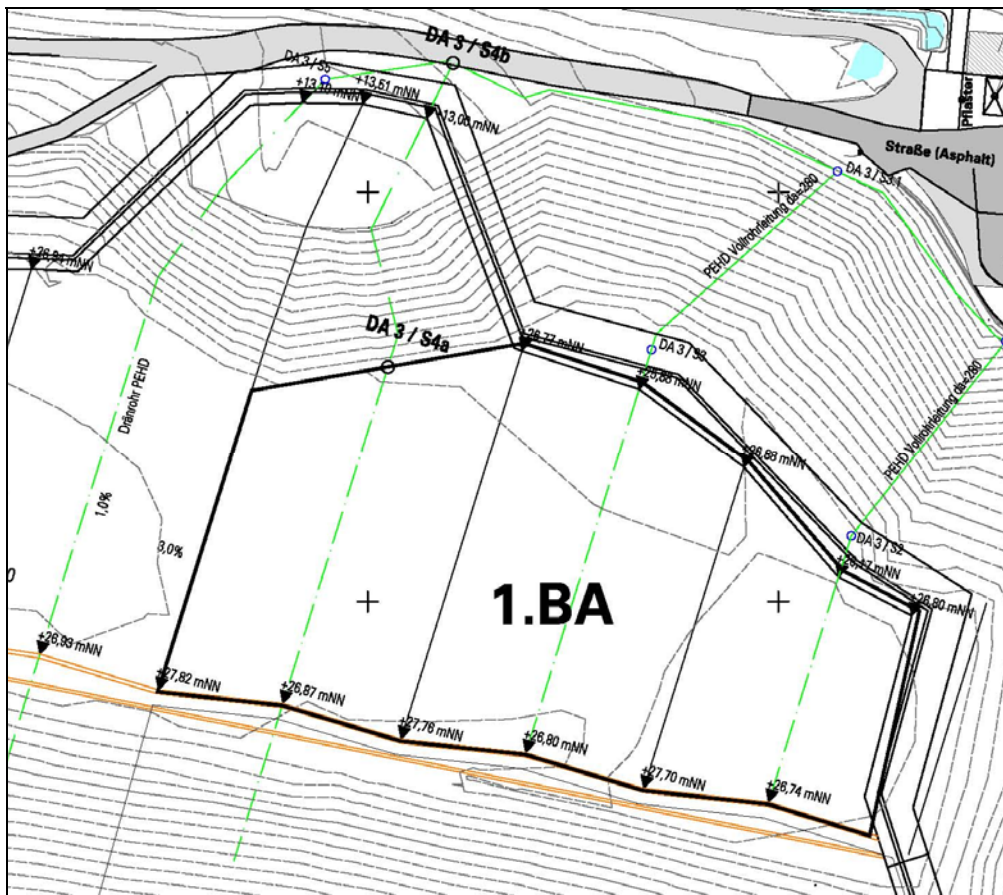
Lageplan 1. Bauabschnitt im DA 3
